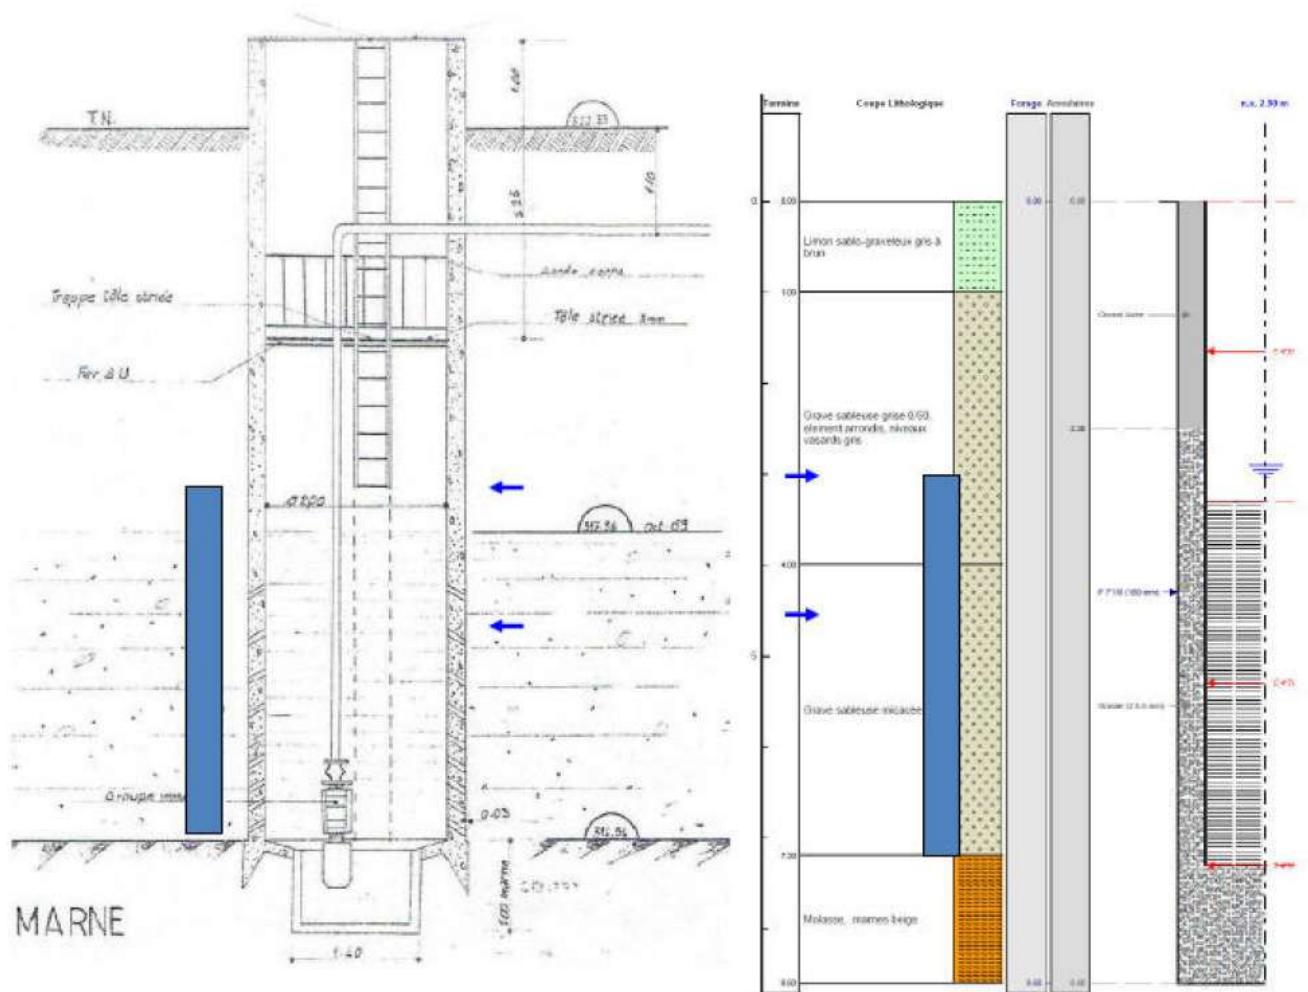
Plus hautes et plus basses eaux en 2015 à Campestre et P4, section mouillée aquifère en 2017
